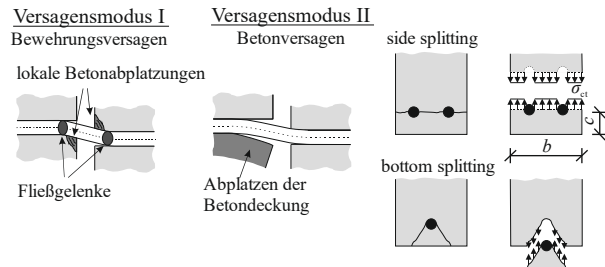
Dübelversagensarten in Stahlbetonbauteilen nach [16, 20]
